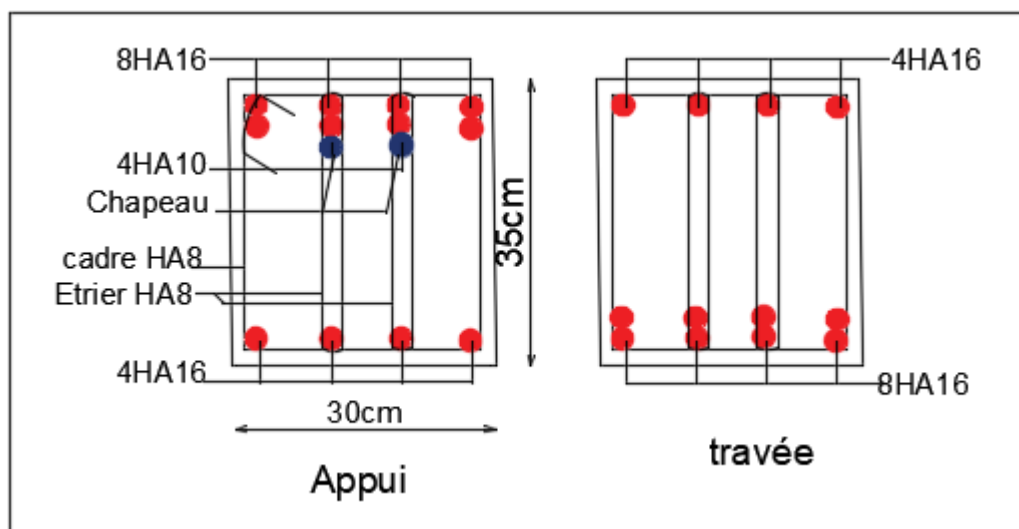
Schéma de ferrailage de la poutre secondaire du plancher étage 4
